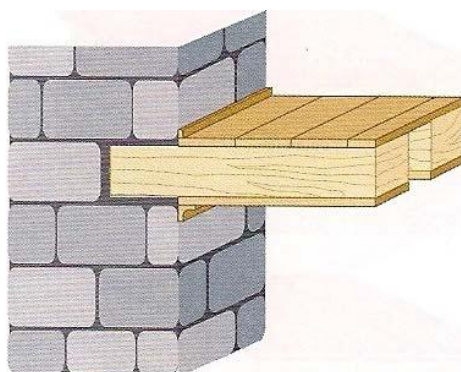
Ligação entre o pavimento de madeira e uma parede de alvenaria [1]
